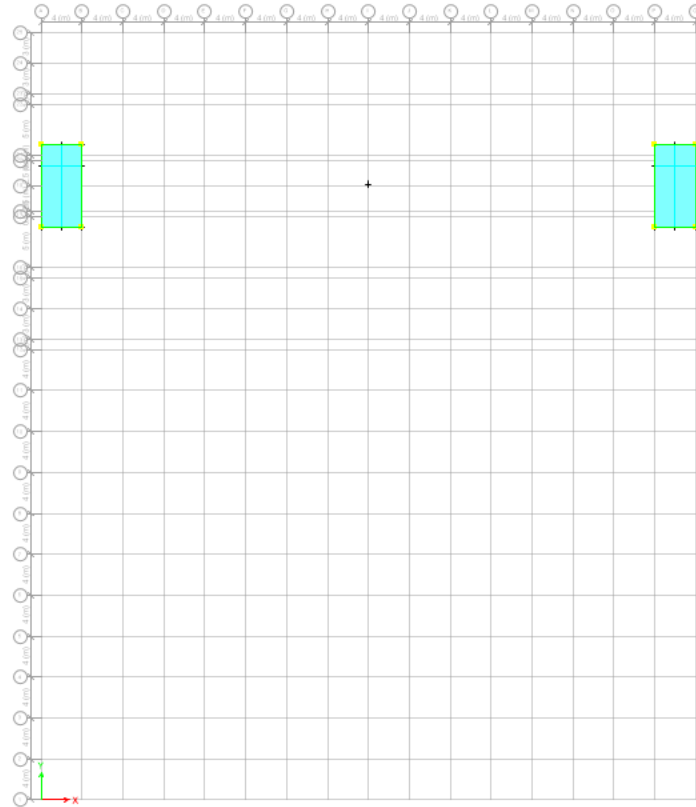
Denah Tipikal Lantai 7 dan 9 Untuk Model 4
